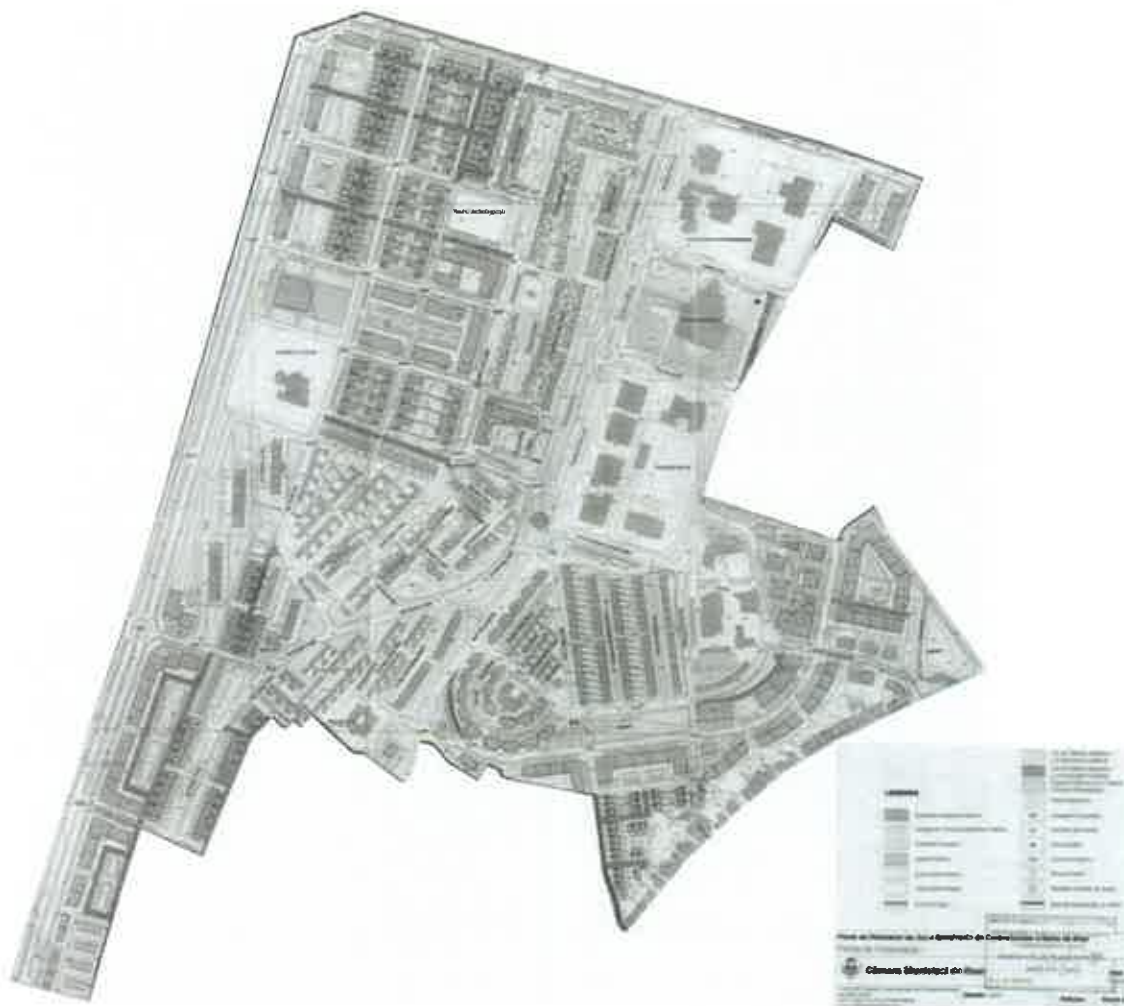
Planta de Implantação, Plano de Pormenor da Área Envolvente do Núcleo Escolar a Norte de Ovar – RCM n.º 70/2007
